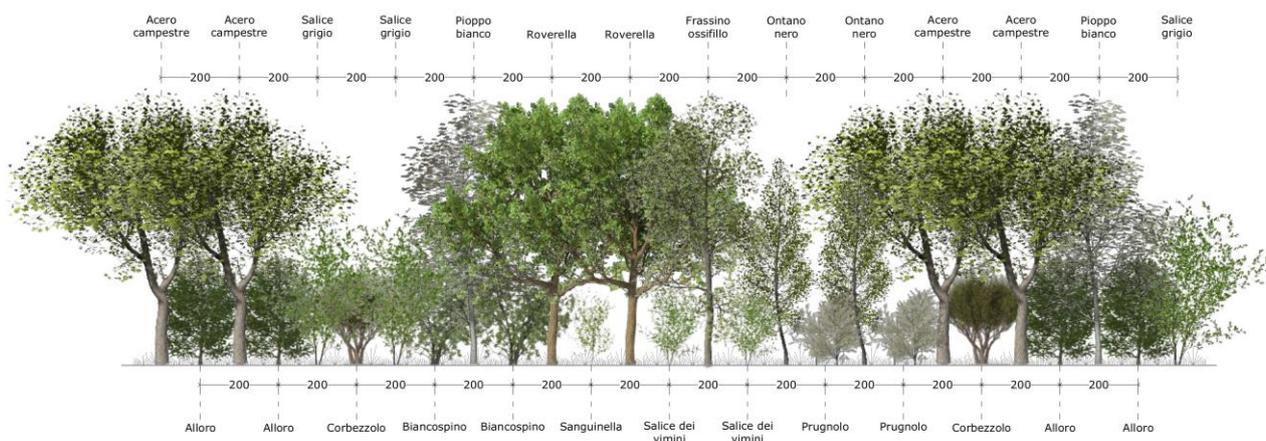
Prospetto mitigazione tipo 1a - campo 2
